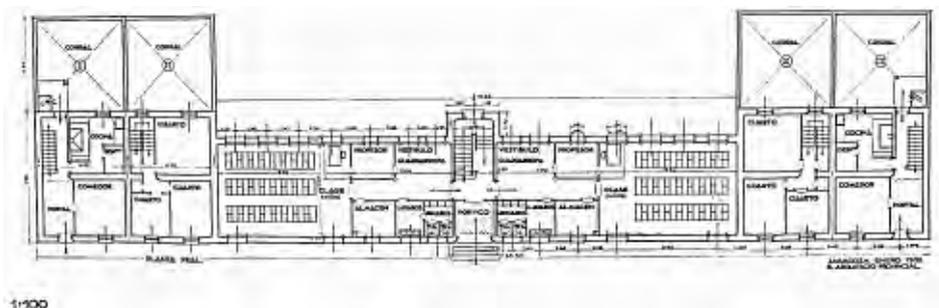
Planta baja de las escuelas y viviendas para maestros de Arándiga, por el arquitecto Teodoro Ríos, enero de 1932 (Archivo de la Diputación Provincial de Zaragoza).
